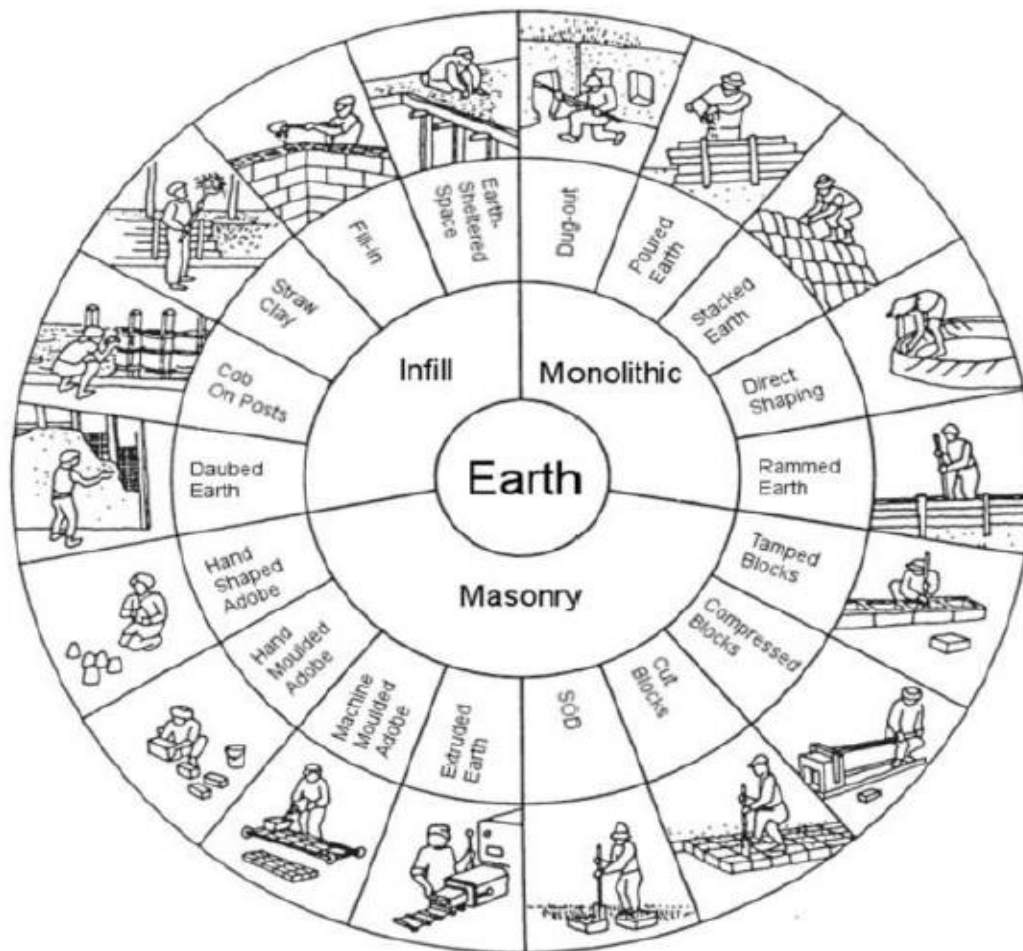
Técnicas de construção de terra (retirado de Houben and Guillaud (2008))
